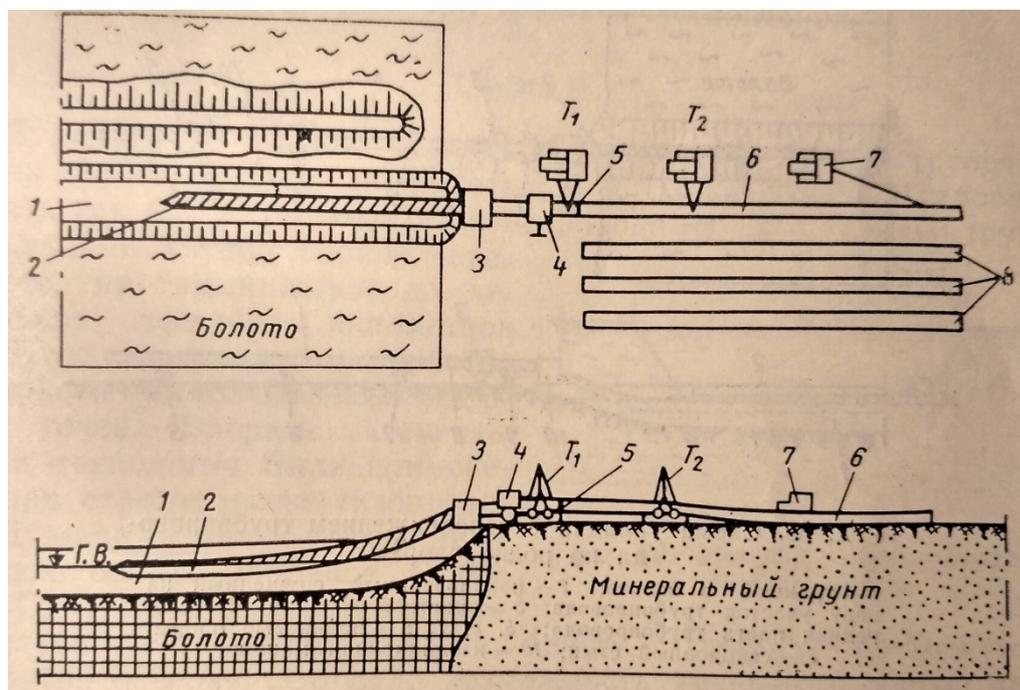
Схема укладки трубопровода сплавом для варианта 1 [2]
